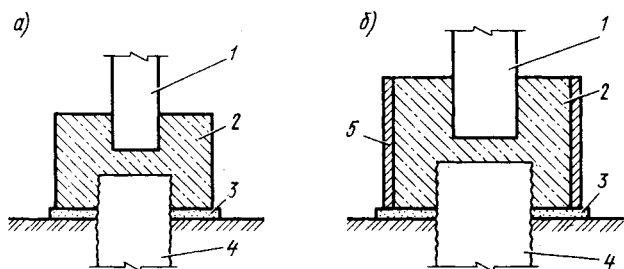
Конструкции соединений набивных свай с колоннами: а — с помощью монолитного оголовка; б — с помощью сборной насадки; 1 — колонна; 2 — монолитный оголовок; 3 — бетонная подготовка; 4 — набивная свая; 5 — сборная насадка
